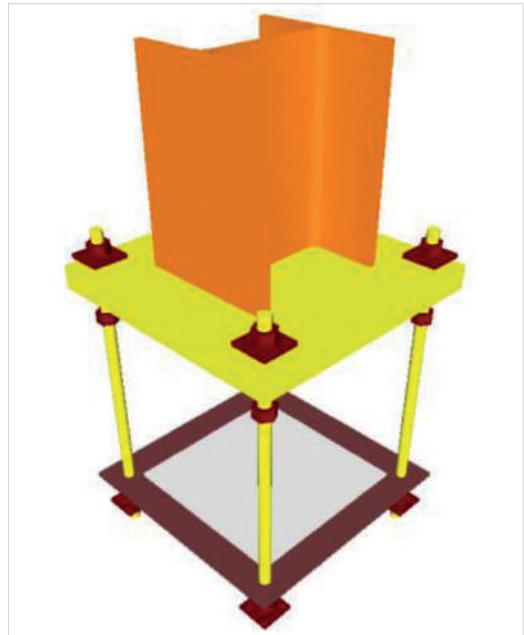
Pilar metálico Nivel de desarrollo 400. Fuente: BIM Forum 2013, B 1010.10\_Floor Structural Frame\_Steel Framing Columns
